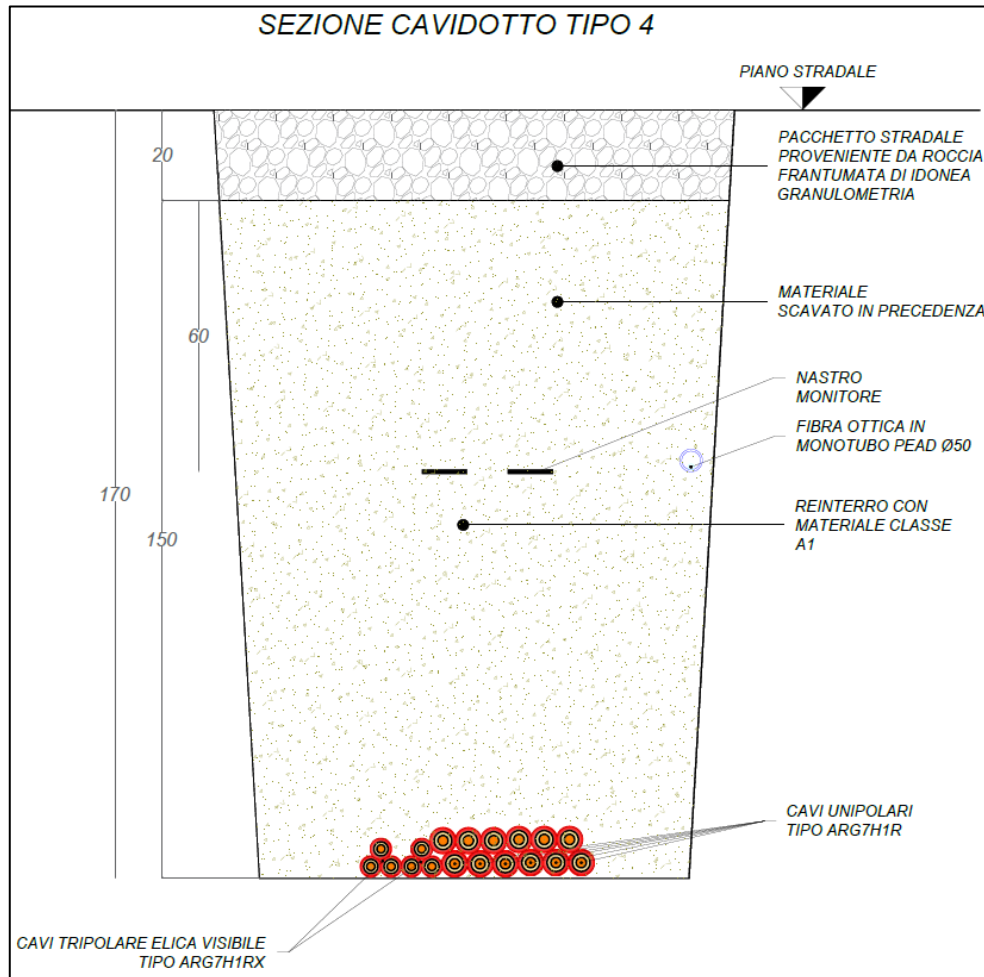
Sezione di posa cavidotto MT a 30 kV – tipo 4
